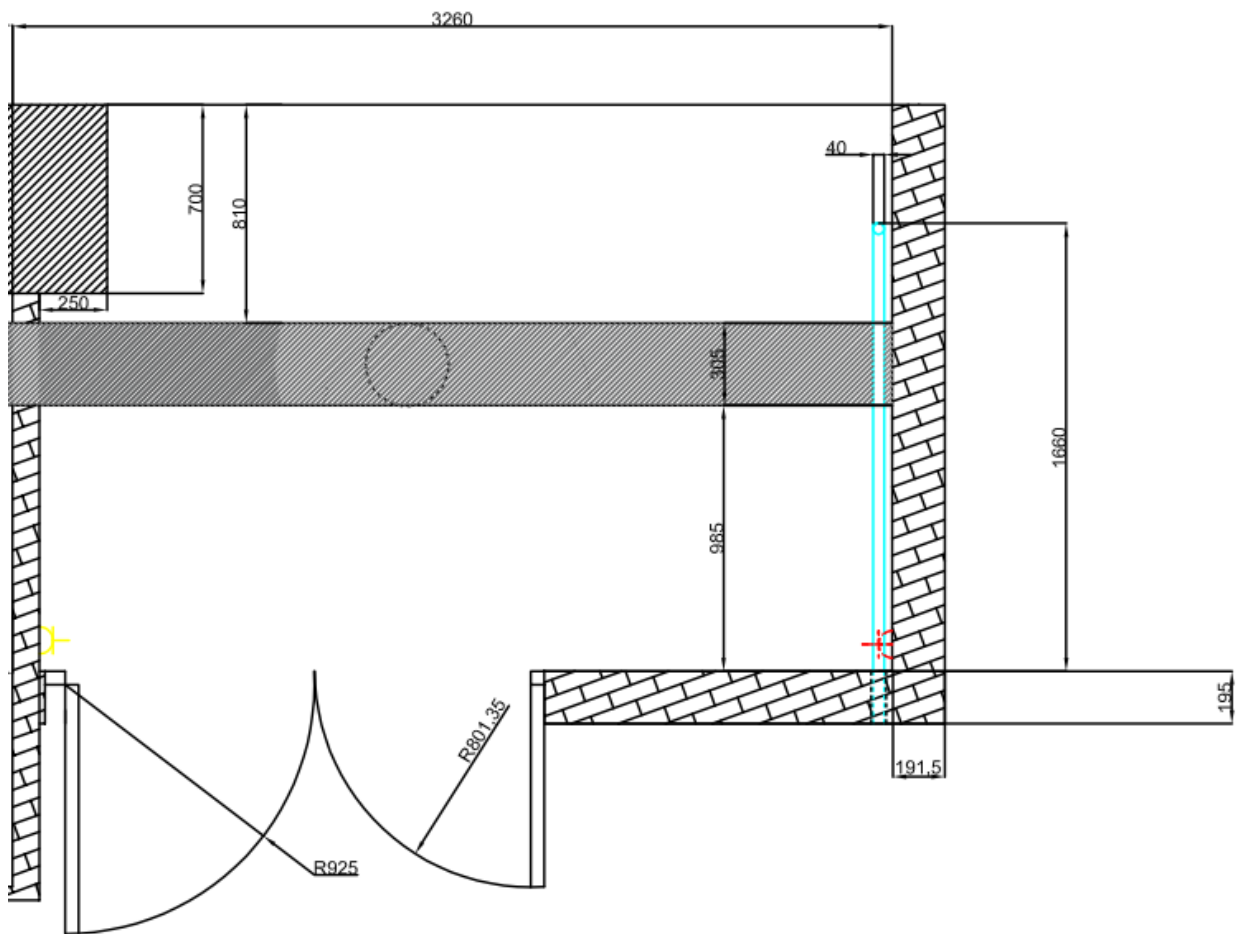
Planos en planta acotado sala 1. Fuente: propia. Realizado en AutoCAD.
